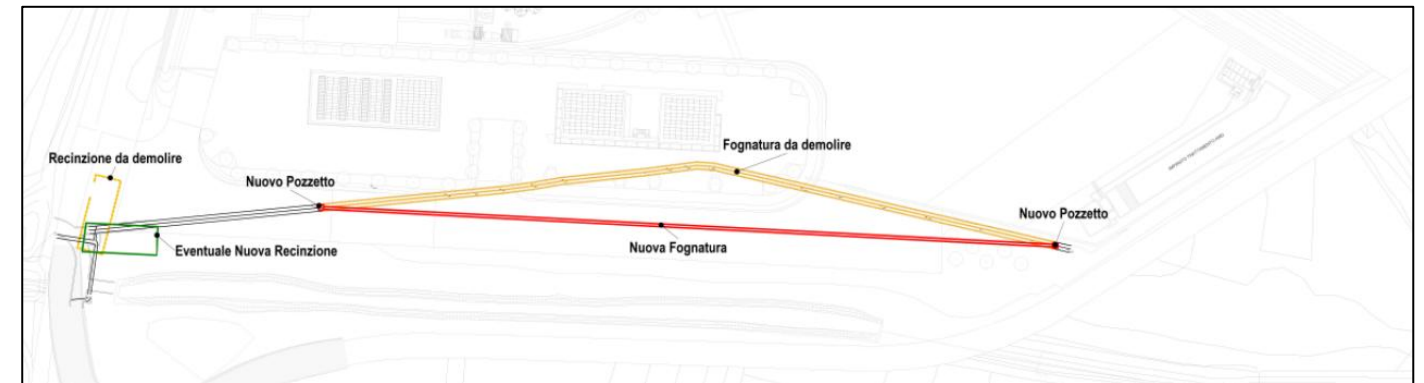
Planimetria risoluzione interferenza con fognatura Publiacqua
